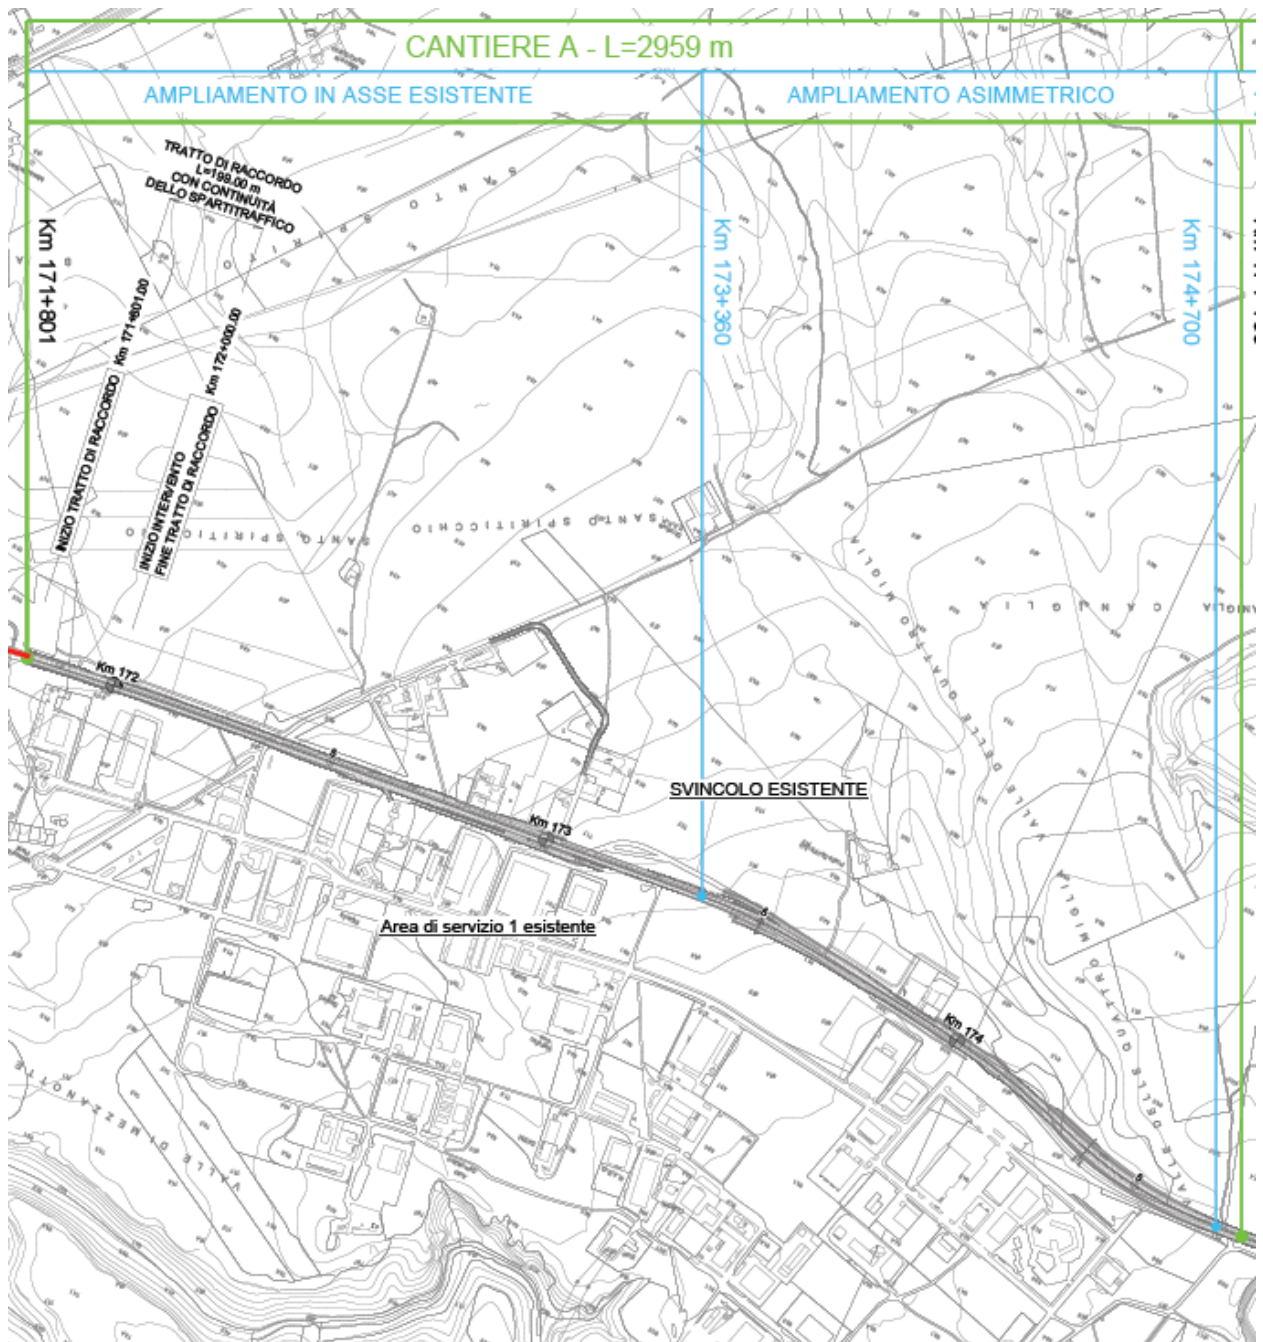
Stralci planimetrici con localizzazione Cantiere A
